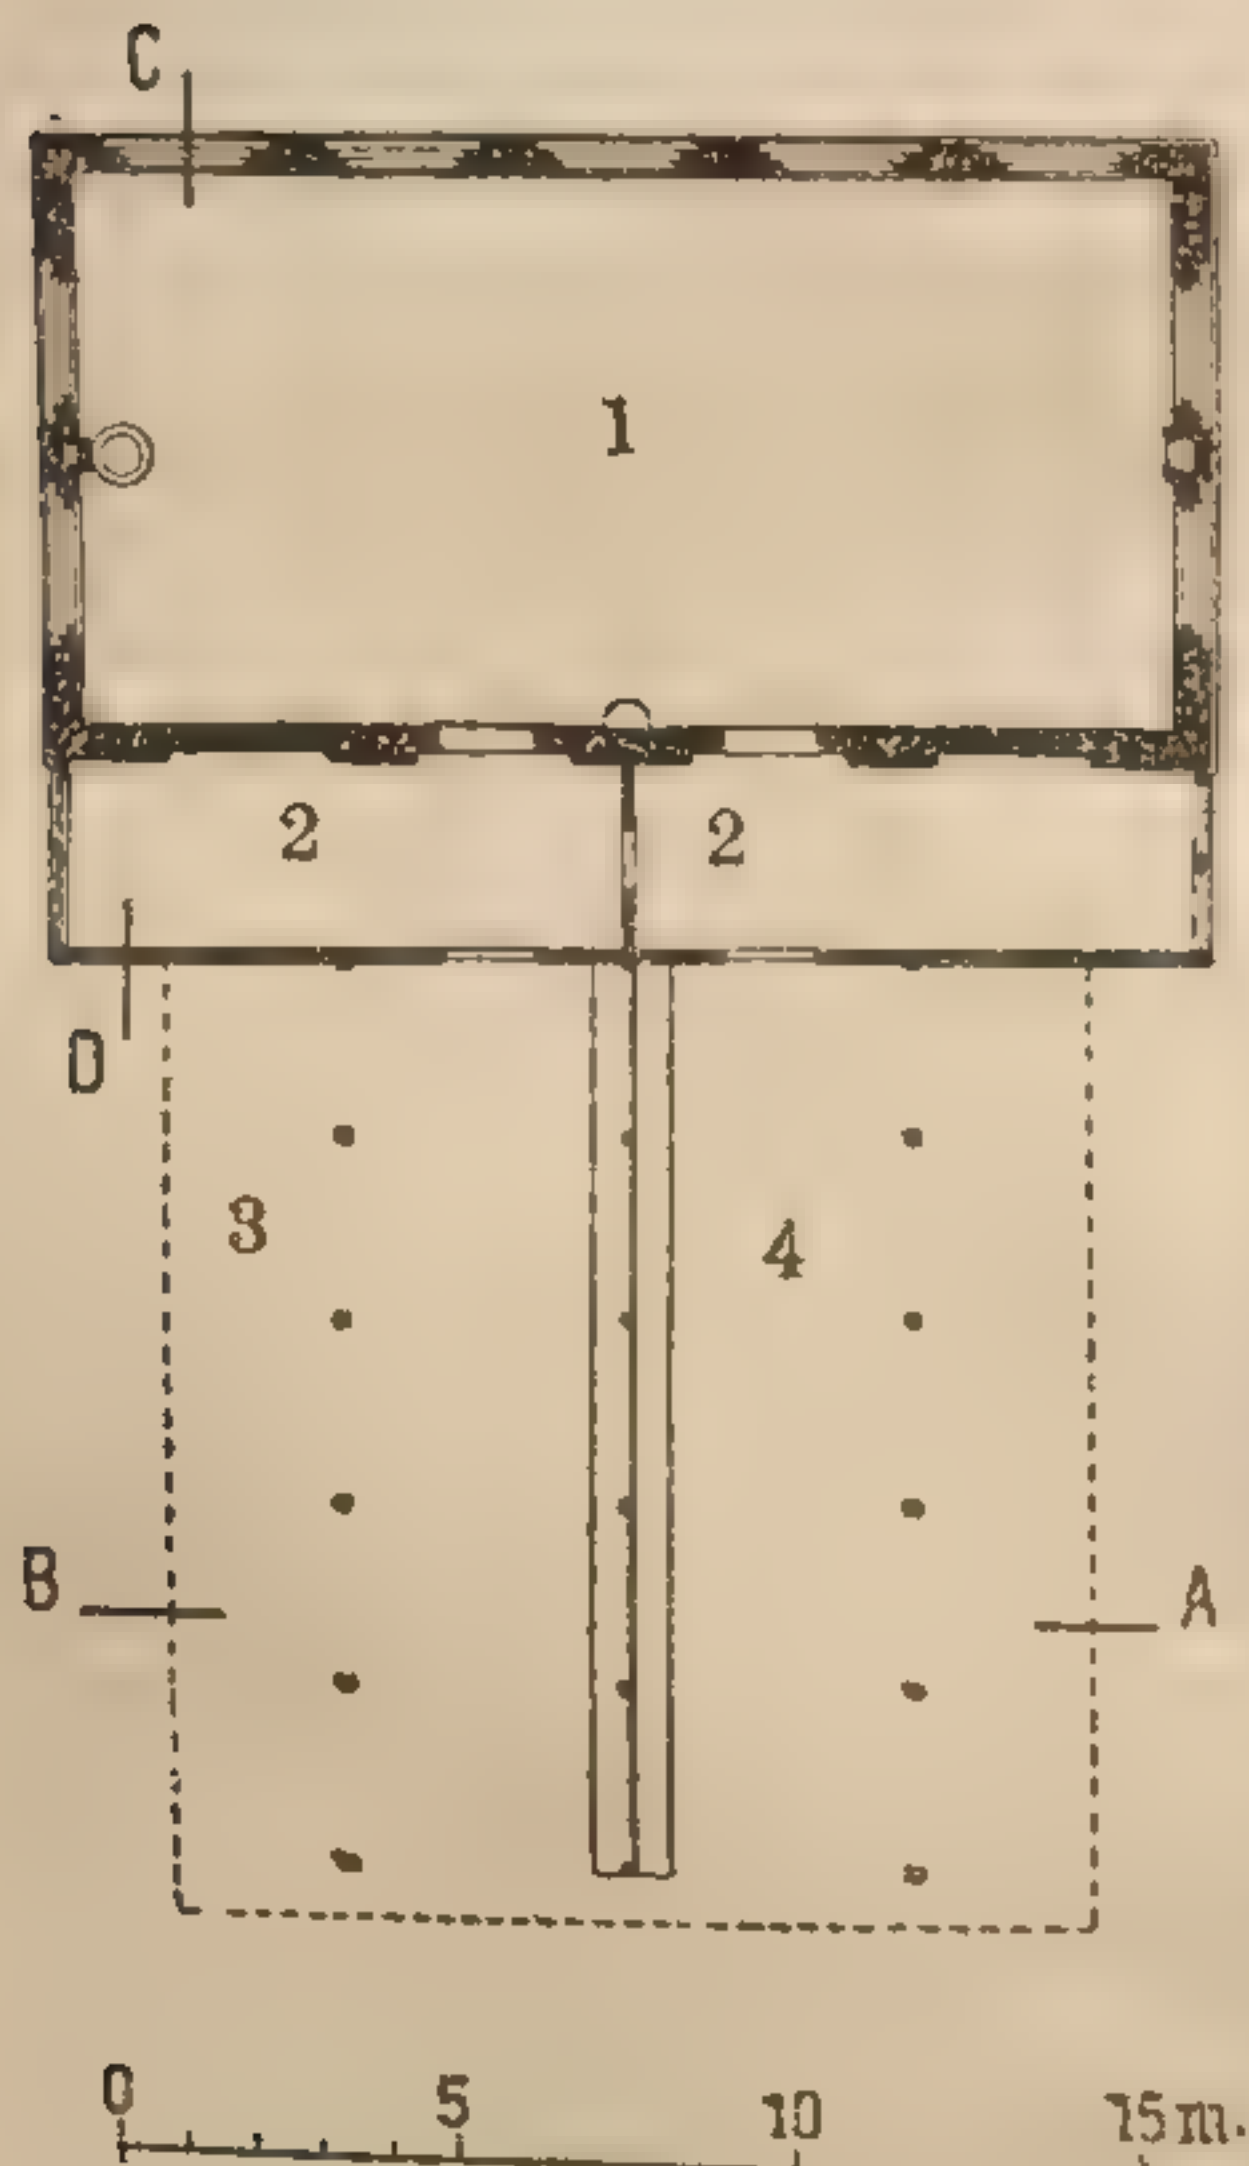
План гимнастического зала и крытой площадки для игр к рис. 257. 1. Гимнастический зал, 2. Раздвальная, 3. Крытая площадка для мальчиков, 4. Тоже для девочек.
